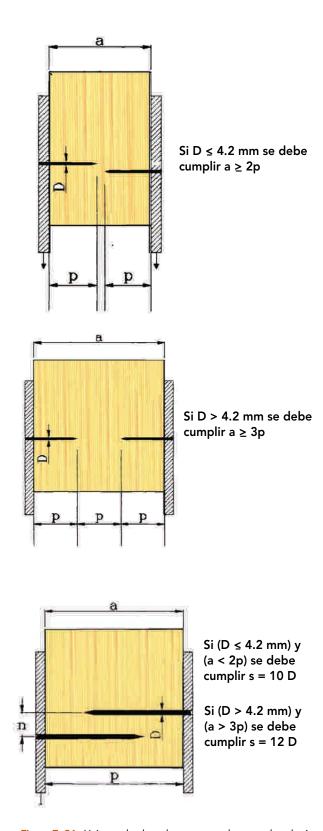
24: Uniones de placa de acero y madera con clavado sin disposición alternada.
